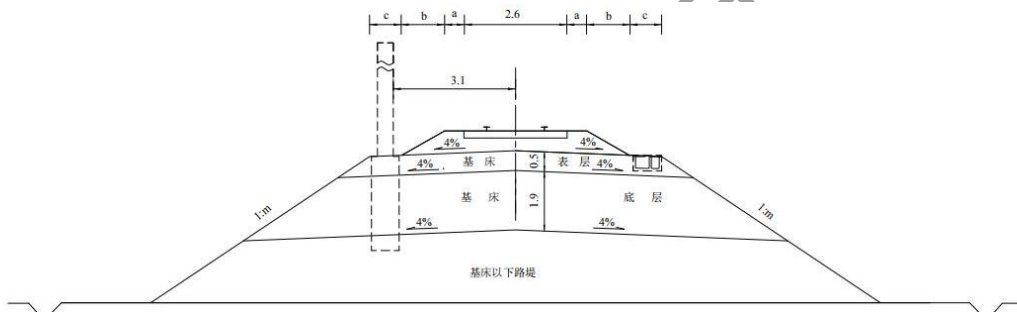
有砟轨道单线路堤横断面图 (单位: m)
